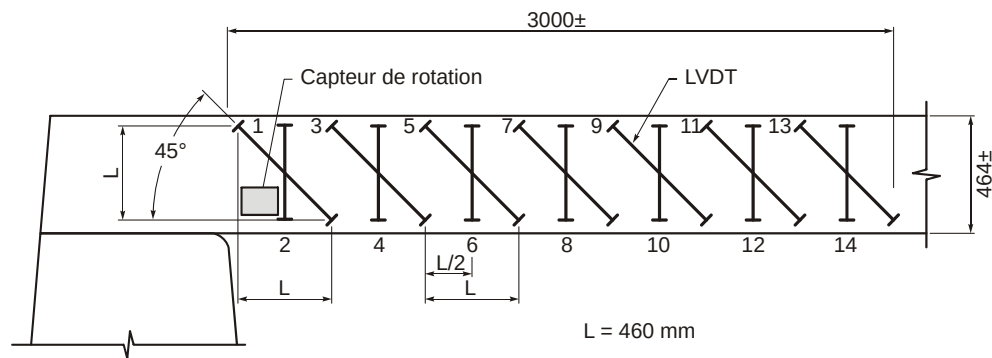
Disposition des capteurs LVDT sur la travée Sud – Essai 2
